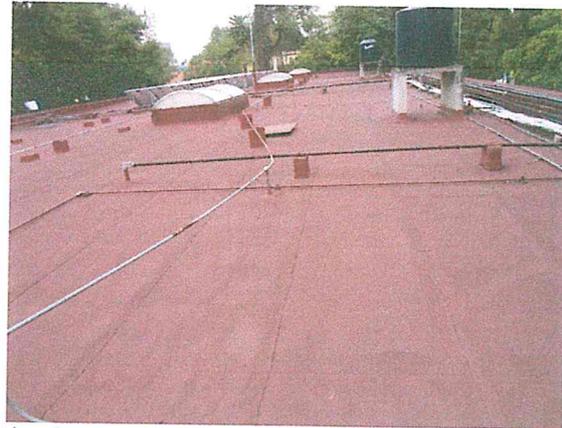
Losas planas de la azotea, sin afectaciones estructurales.
